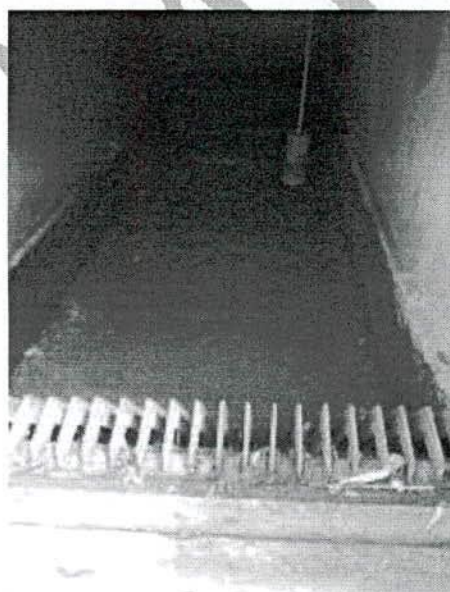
ETE Ipanema – Gradeamento Grosso
